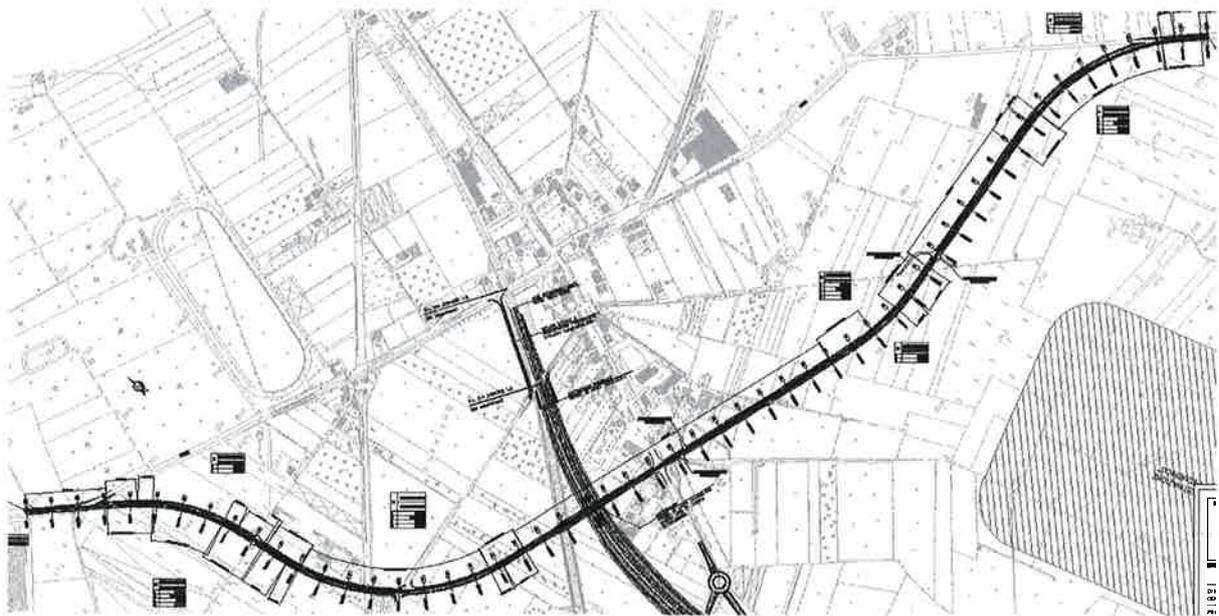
Stralcio planimetrico del PP di L.O. – NV 10
